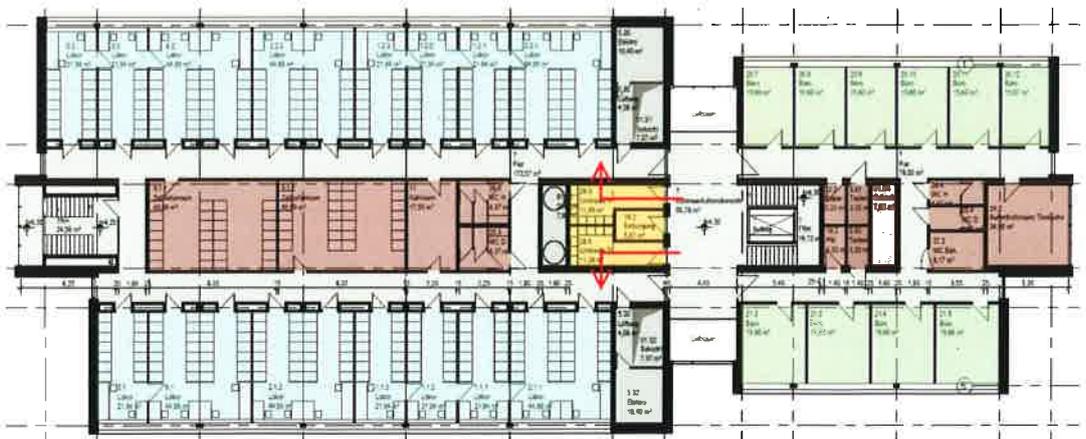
Grundrisslayout – Zonierung Labortrakt (mit Schleusen bei Bedarf) und Bürotrakt
